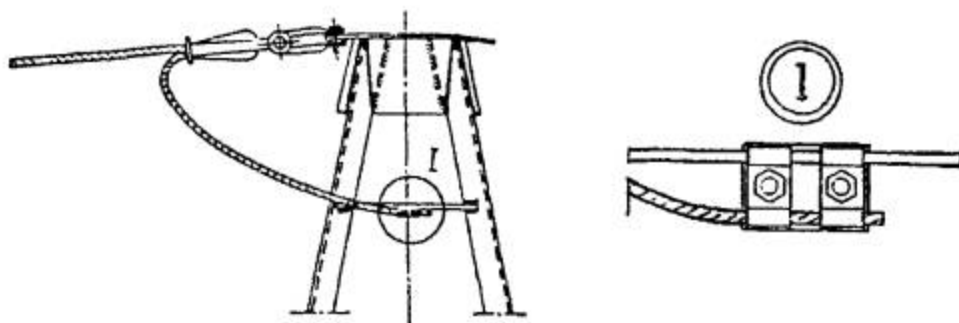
Закрепление тросового молниеприемника на несущей конструкции
